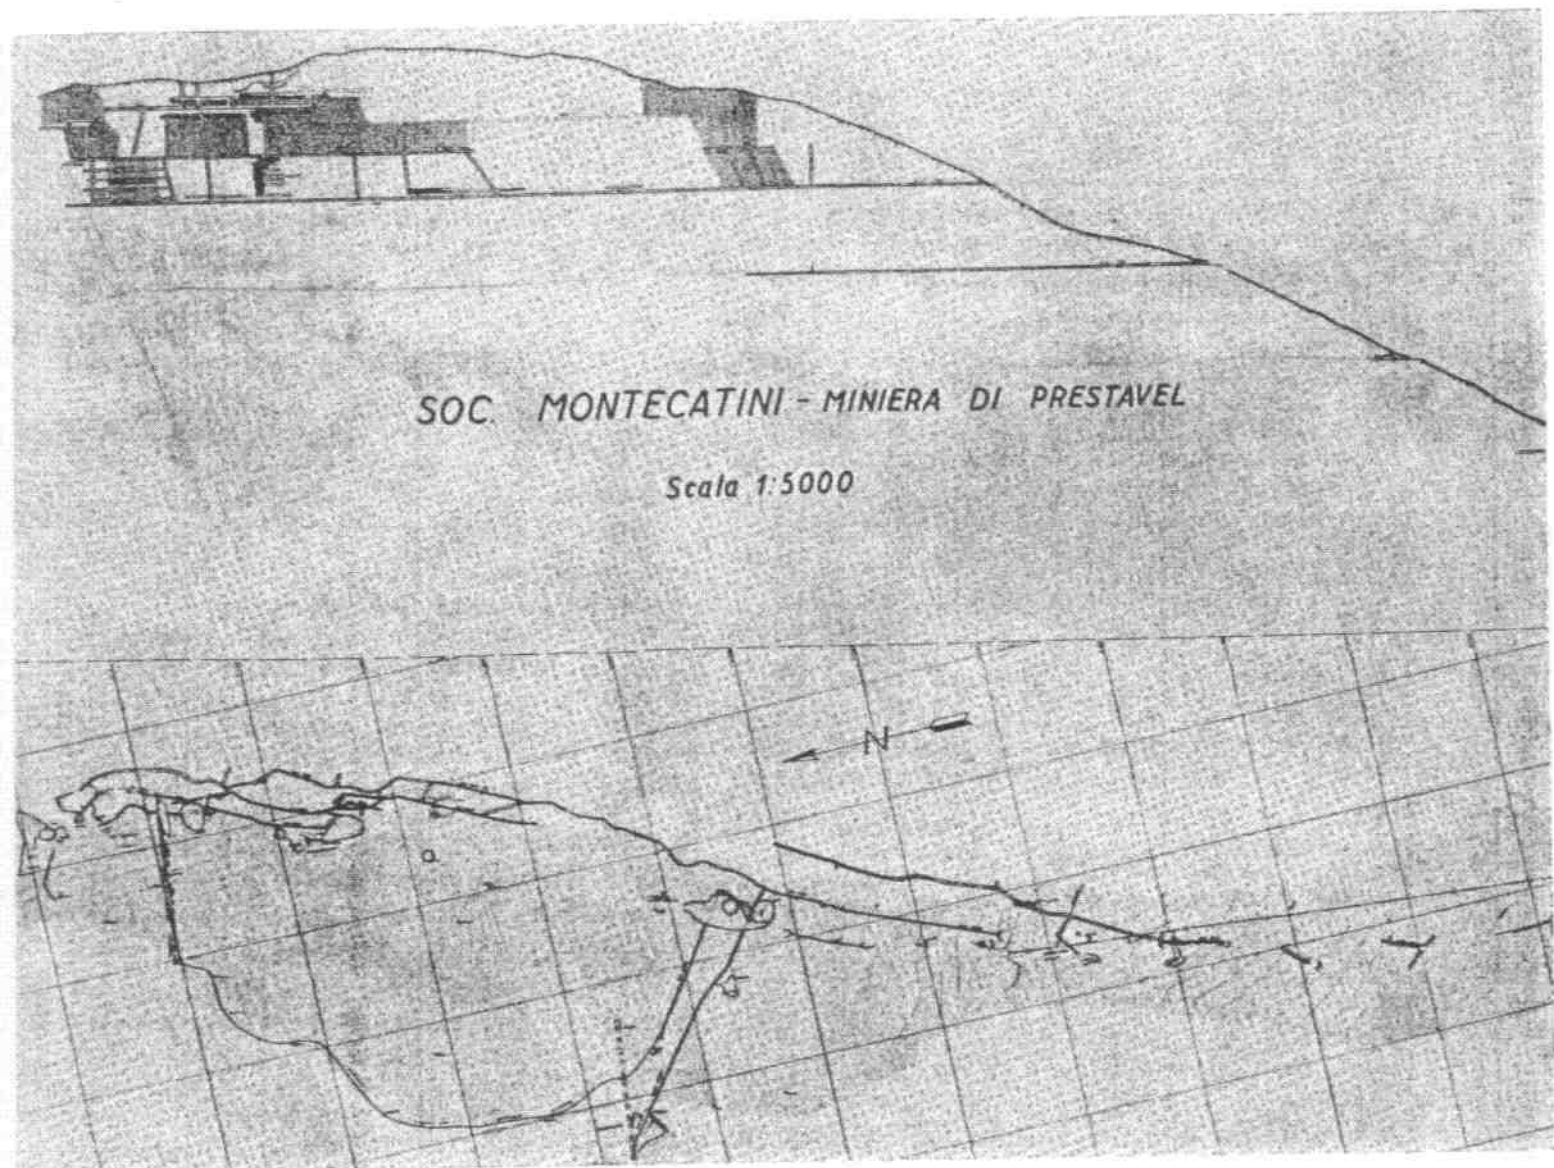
Sezione e pianta della miniera di Prestavel, scala 1 : 6.000 circa.
